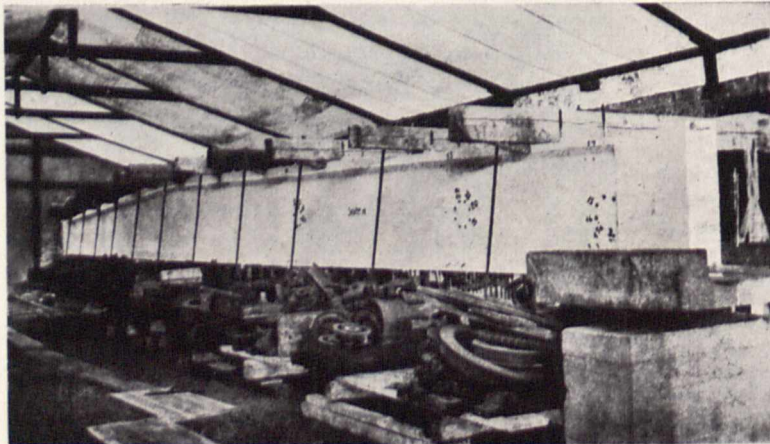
Spannbetonbalken während einer Probebelastung mit 1620 kg je lfm
